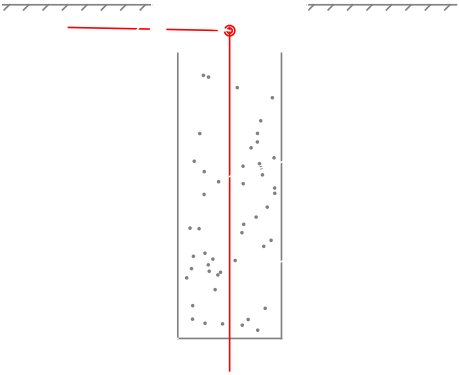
Plano de Detalle del Sistema de Puesta a Tierra
